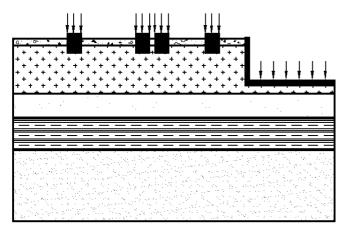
Расчетная схема участка с наиболее неблагоприятным влиянием фундаментов
